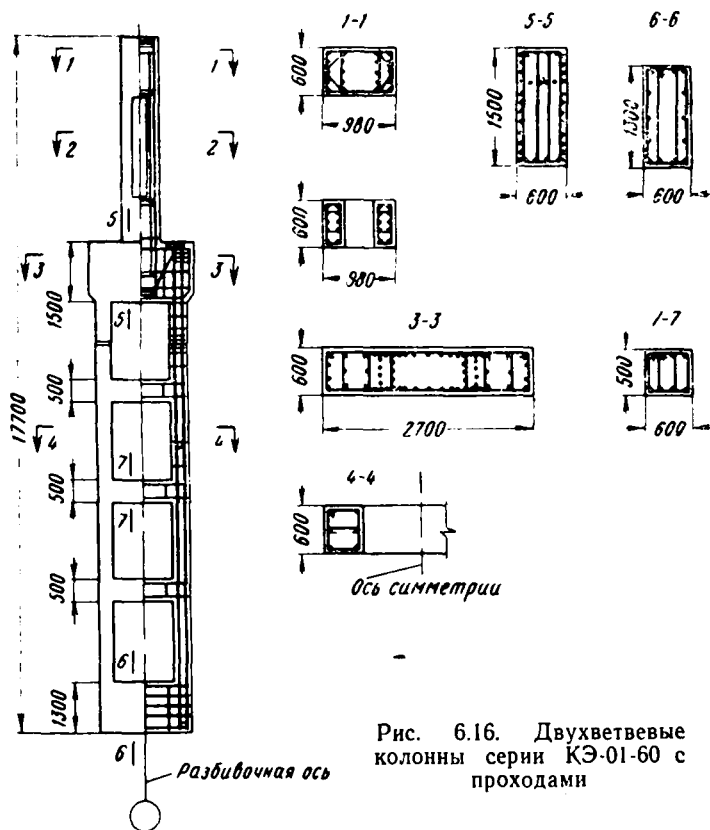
Двухветвевые колонны серии КЭ-01-60 с проходами
